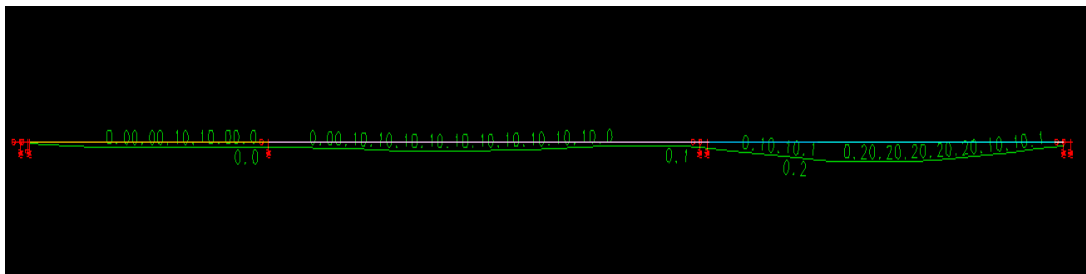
Deslocamentos verticais da viga V11 do 1º pavimento, concreto armado (CAD/TQS)
